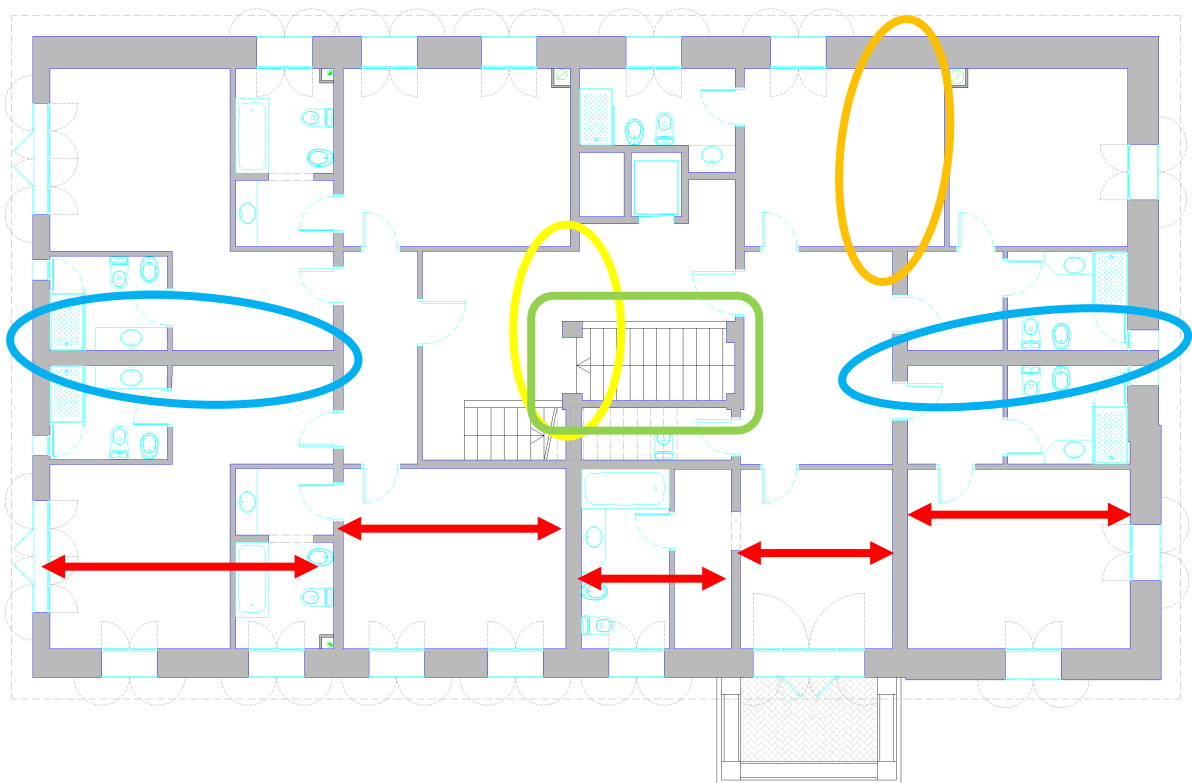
Plano planta primera (Fuente: Propia)
